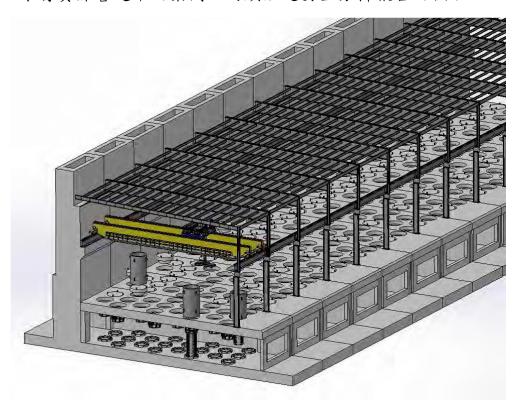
密封鋼筒混凝土貯存窖示意圖 四、混凝土模組貯存設施
